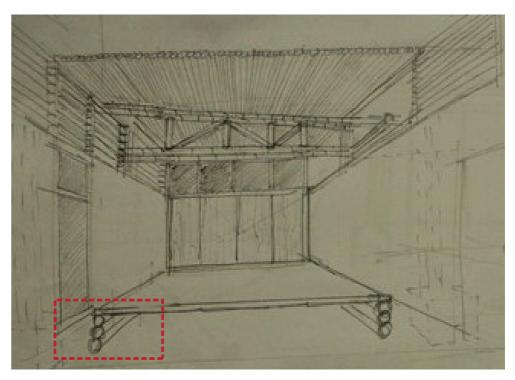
Esquema de sistema constructivo del proyecto. Fuente. Villacres, 2015
